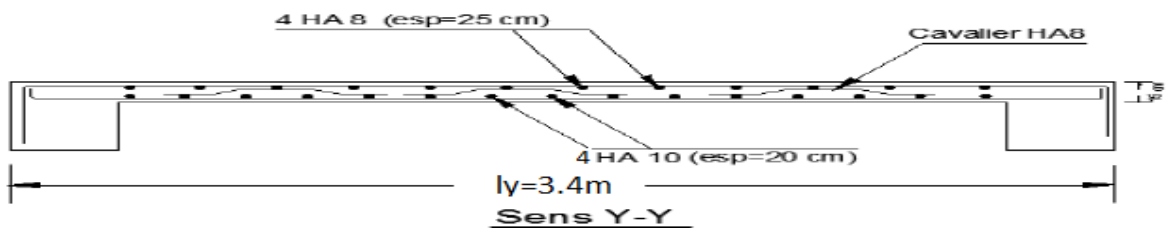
ferrailage de la salle machine sens (y-y)
